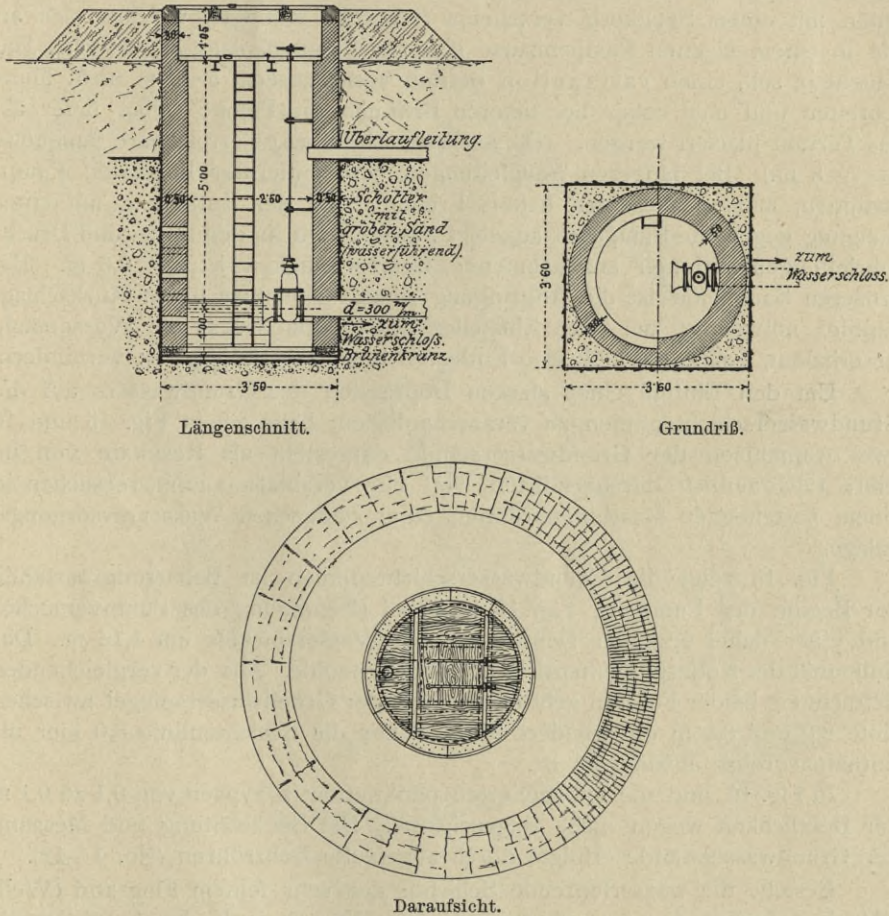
Saugbrunnen für Gravitationsleitungen.
